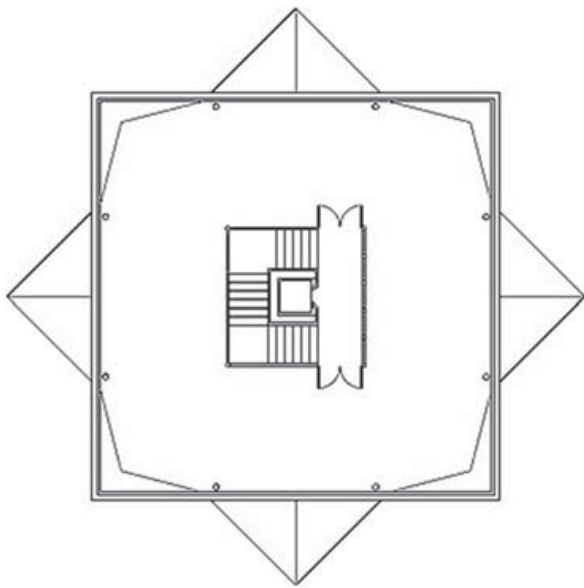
Miguel Fisac. *Torre de Laboratorios Jorba*. Madrid, 1965-68. Planta tipo
